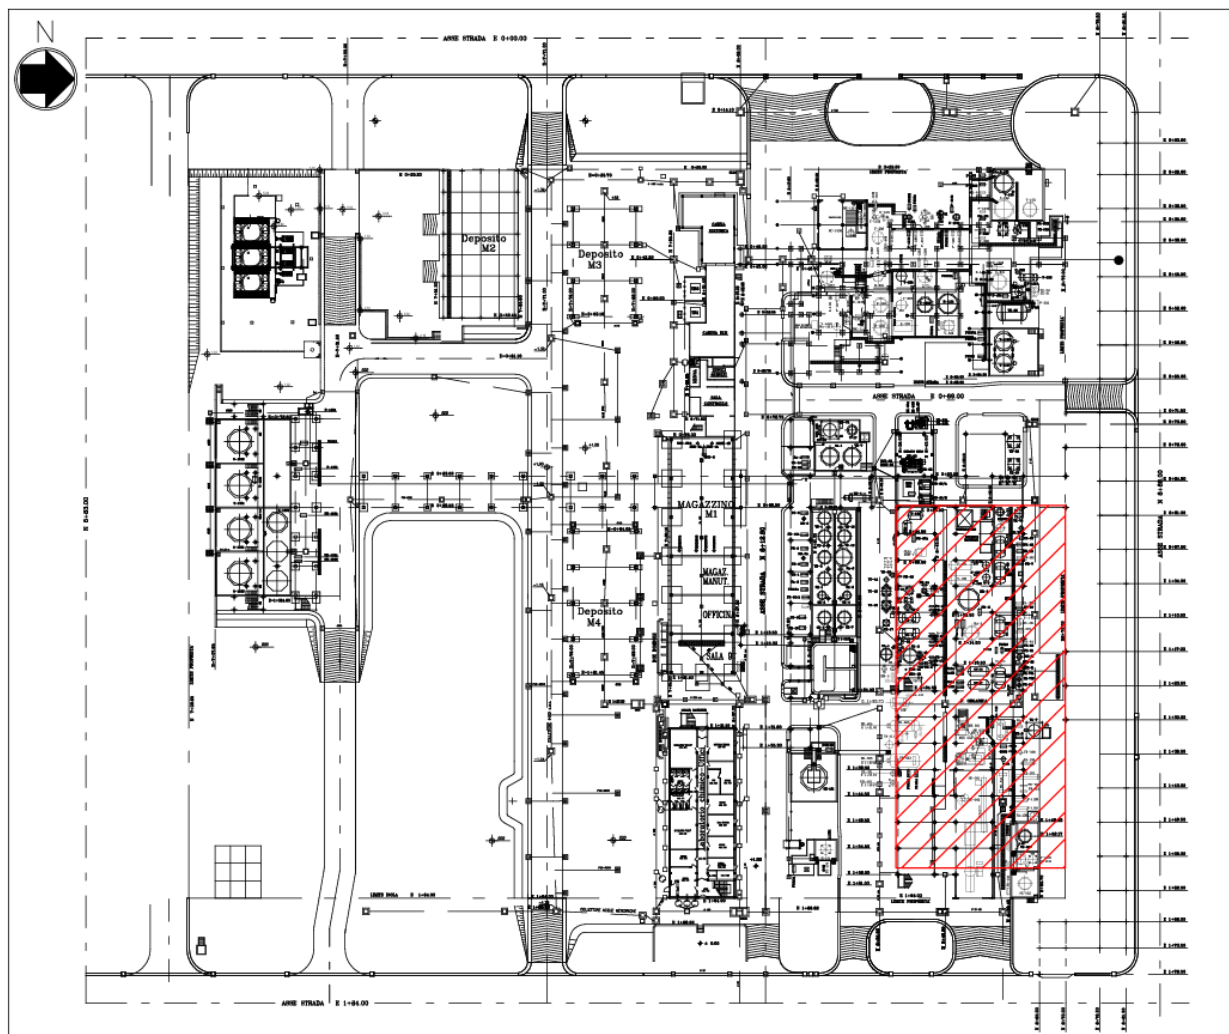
Planimetria generale dello Stabilimento con evidenza dell'area interessata dalla realizzazione della linea in progetto
